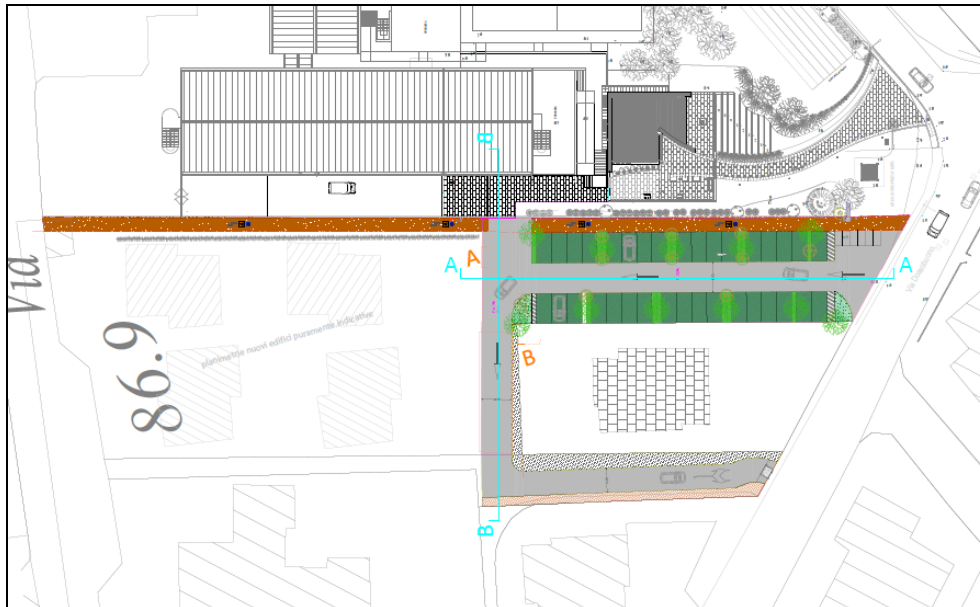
Progetto di fattibilità G.C. 134/16.
